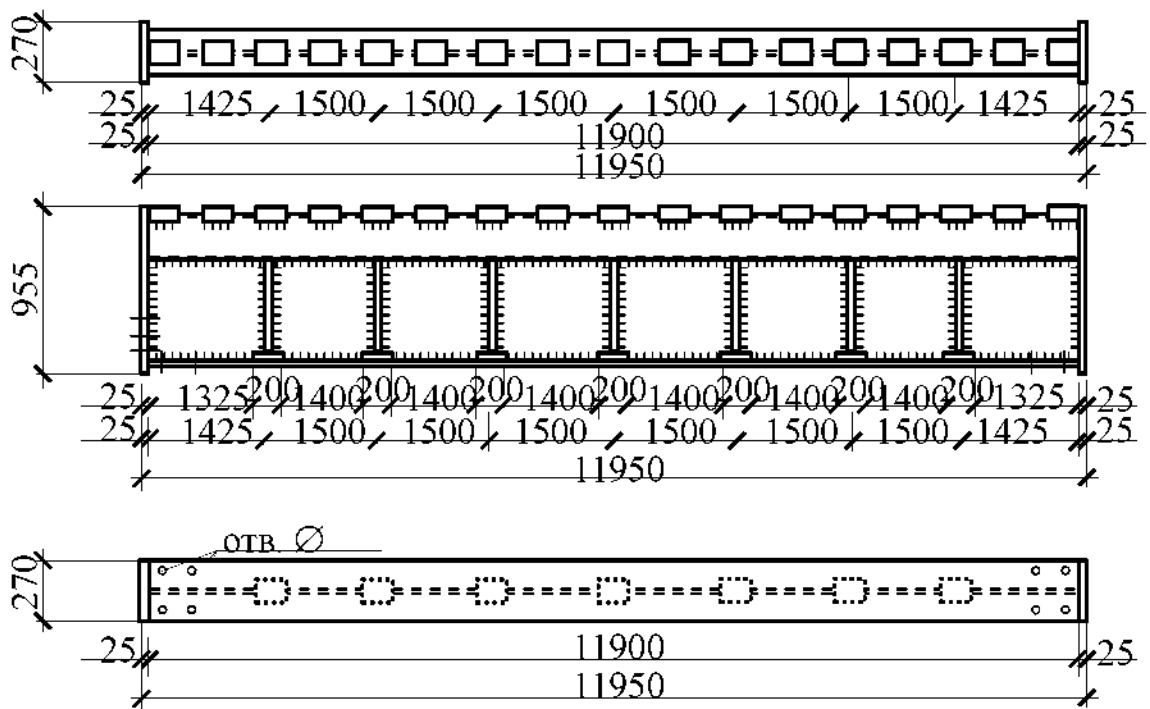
Підкранова балка з верхнім трубобетонним поясом
